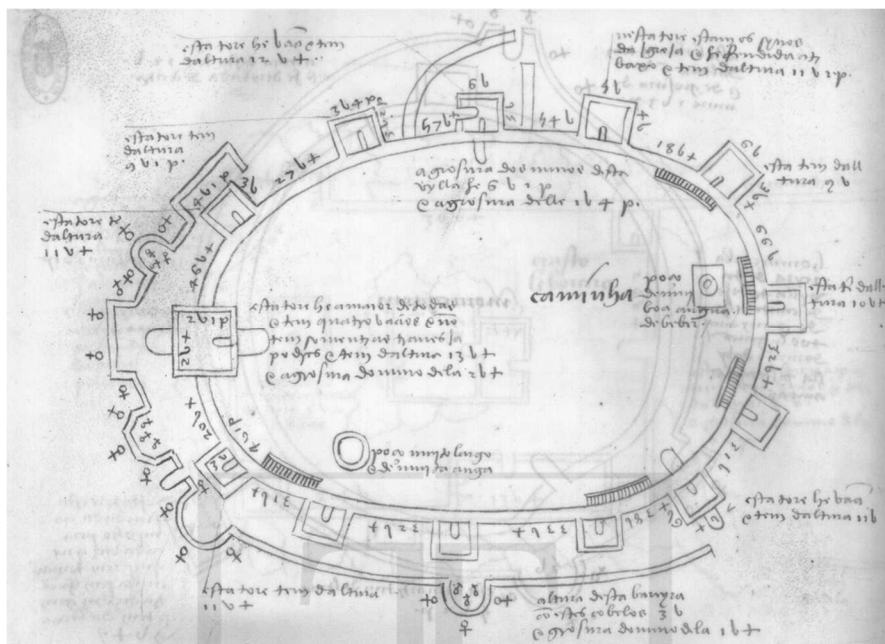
Planta da Muralha – (<http://digitarq.dgarq.gov.pt>)
